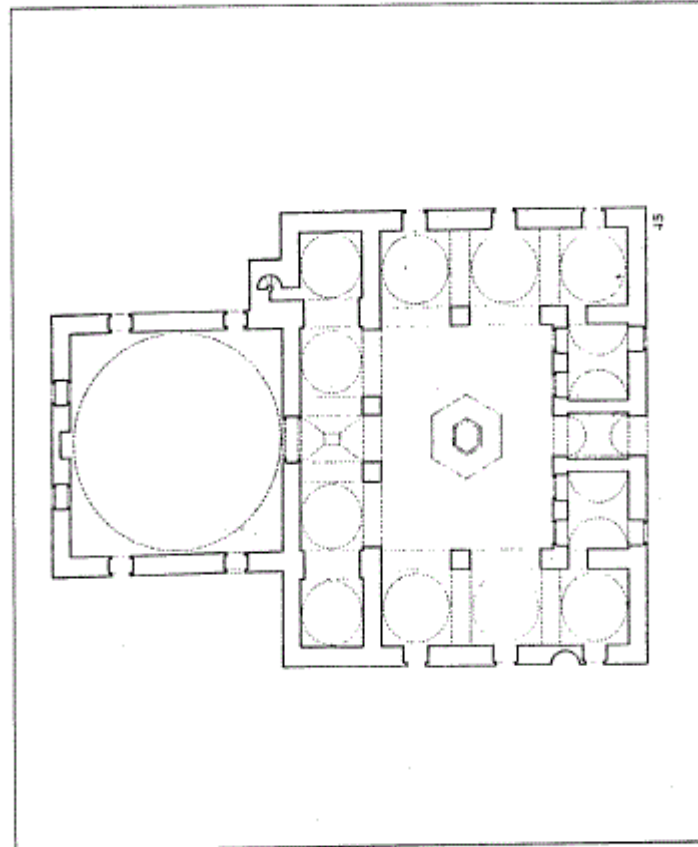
مسقط أفقي لمسجد شريف خليل باشا المعروف بمسجد تومبول في بلغاريا
